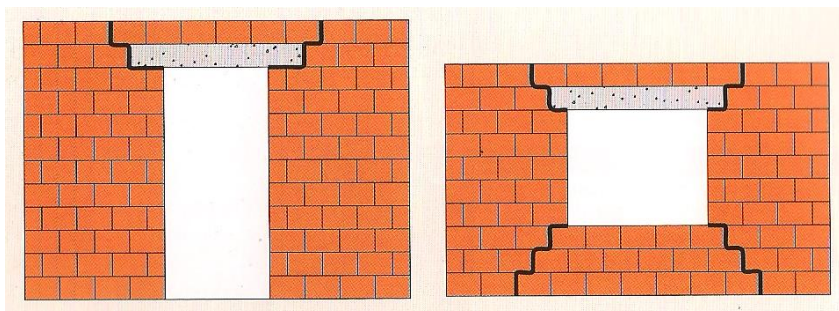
Fissuração típica em zona de vão [27]
